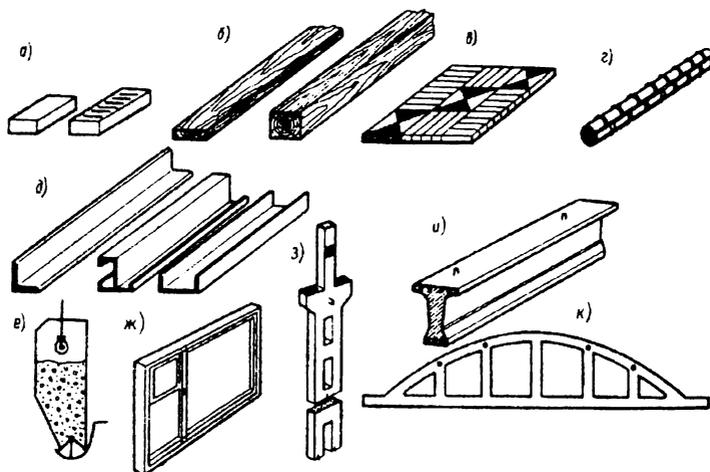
Примеры материальных элементов строительных процессов: а – кирпич (полнотельный и пустотельный); б – деревянные доска и брус; в – паркетный щит; г – арматурная сталь; д – профилированный металл; е – бетонная смесь; ж – оконный блок; з – железобетонная подкрановая балка; и – железобетонная двухветвевая колонна; к – железобетонная ферма.
